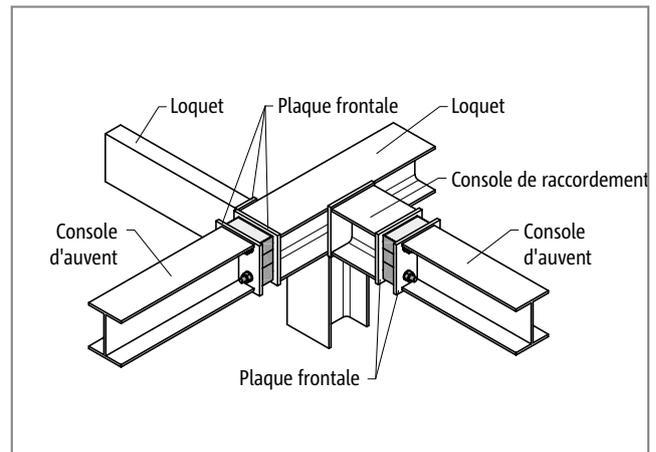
Schöck Isokorb® T type S : coin extérieur
